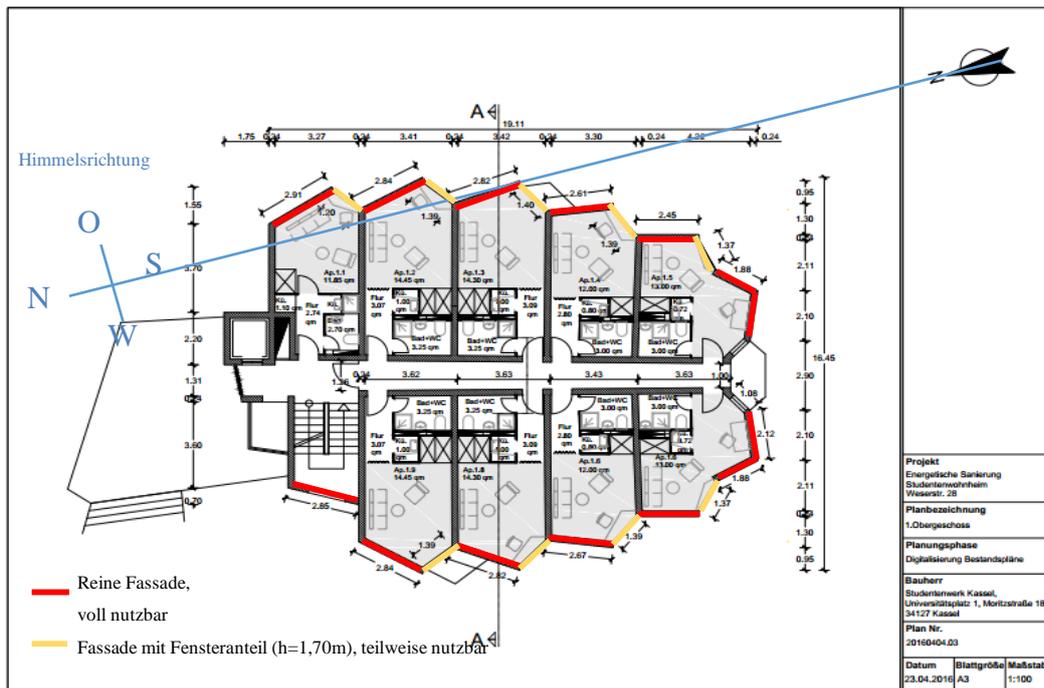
Grundriss Weserstraße 28, markiert für PV-Flächen (eigene Darstellung)
